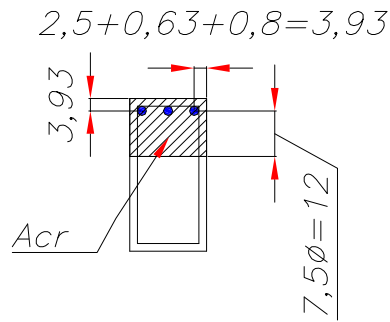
Detalhamento da seção transversal Viga V5 - Momento Negativo
